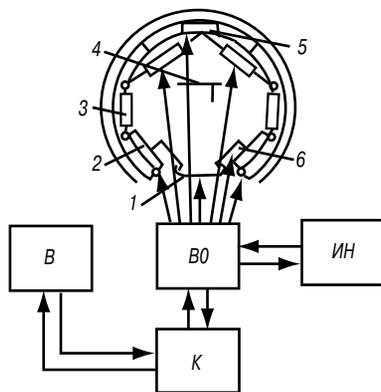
Подсистема «Возведение обделки»: 1 — устройство центровки блоков в лотке; 2 — тележка механизма протаскивания; 3 — его привод; 4 — привод осевого перемещения укладчика; 5 — устройство центровки блоков в зоне свода; 6 — захват
